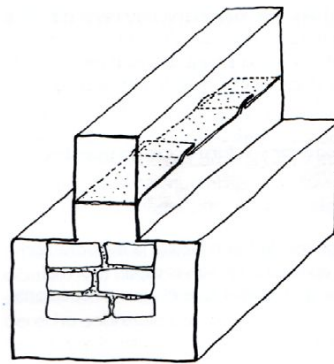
Barrera física con láminas impermeables. (Fuente: Munilla-Lería)
